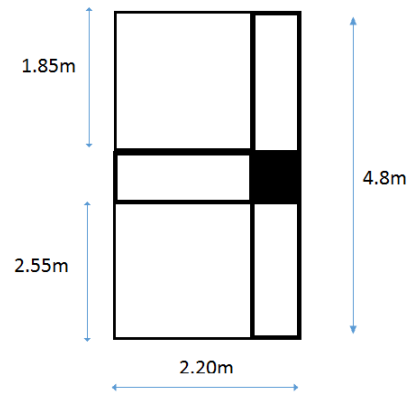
Surface revenant au poteau de rive (poteau A2)
